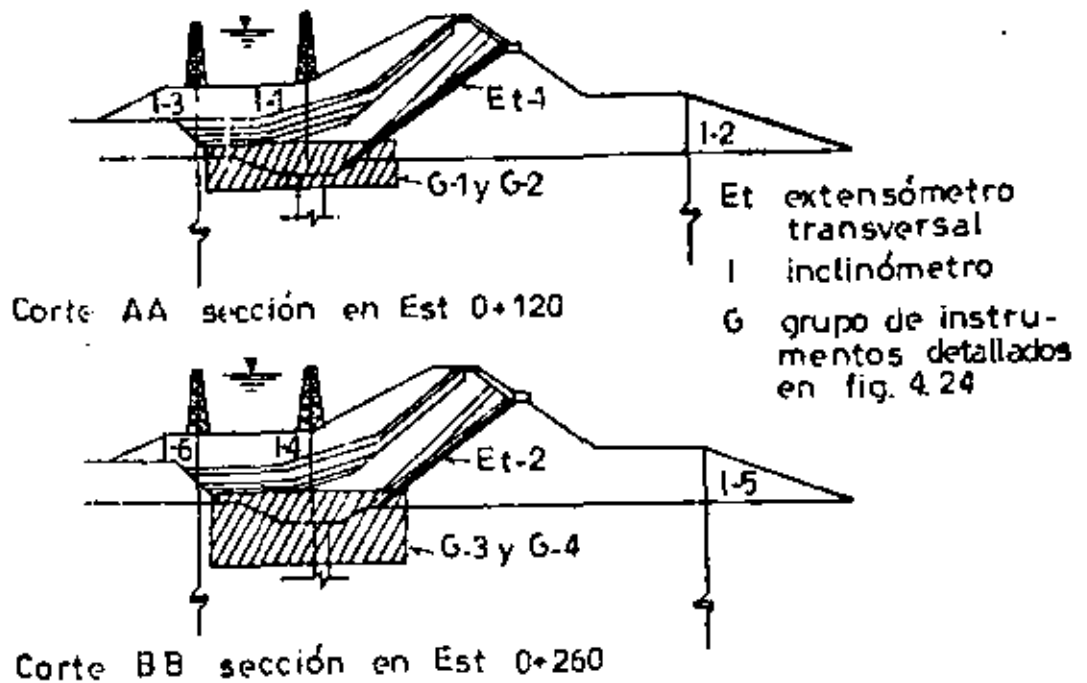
INSTRUMENTACION PRESA GUADALUPE MEX.
